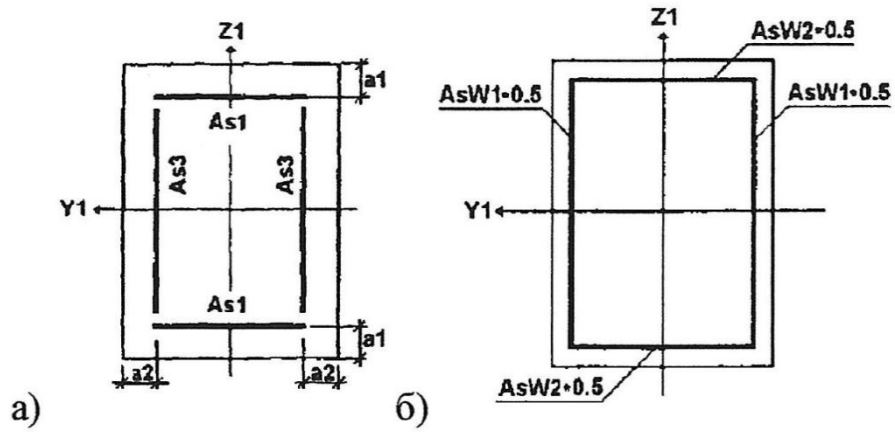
Розташування симетричної а) поздовжньої, б) поперечної арматури у колонах
